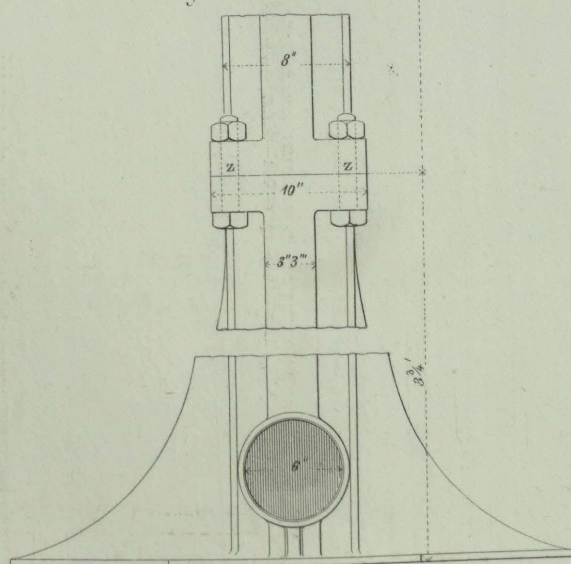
Grundriss vom Fuss der Säule.
